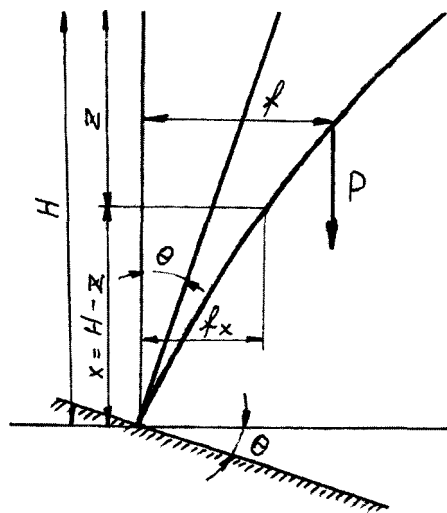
Расчетная схема прогиба трубы от действия ветровой нагрузки с учетом крена фундамента
